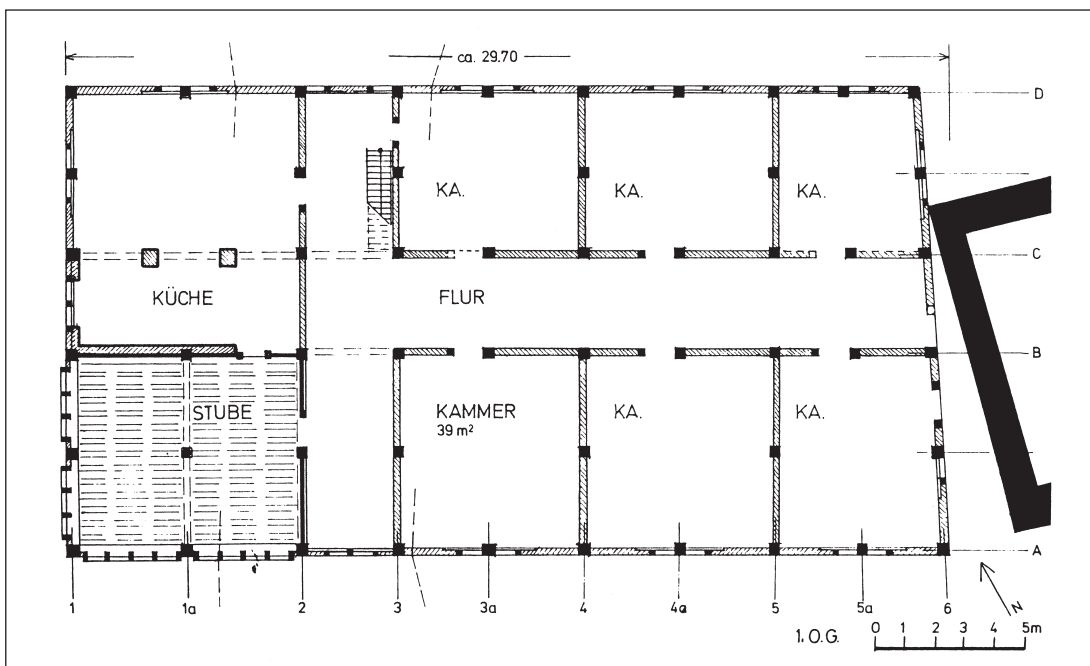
Ehingen, Spital. Grundriss des Obergeschosses des sog. Neuhauses von 1532 mit der typischen Grundrissgliederung eines Pfründerhauses.
